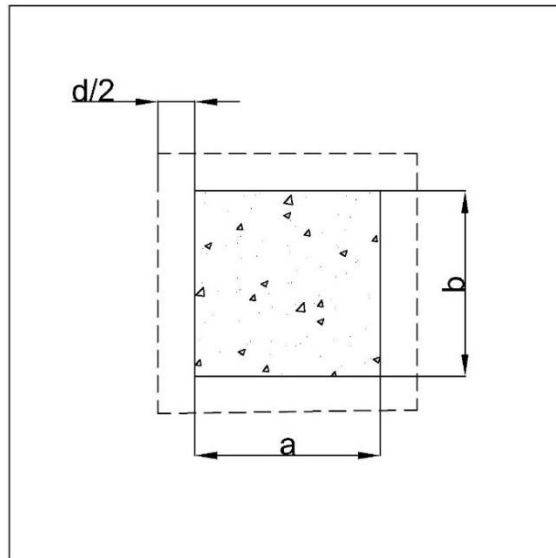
Vista en planta de perímetro crítico de punzonamiento.
